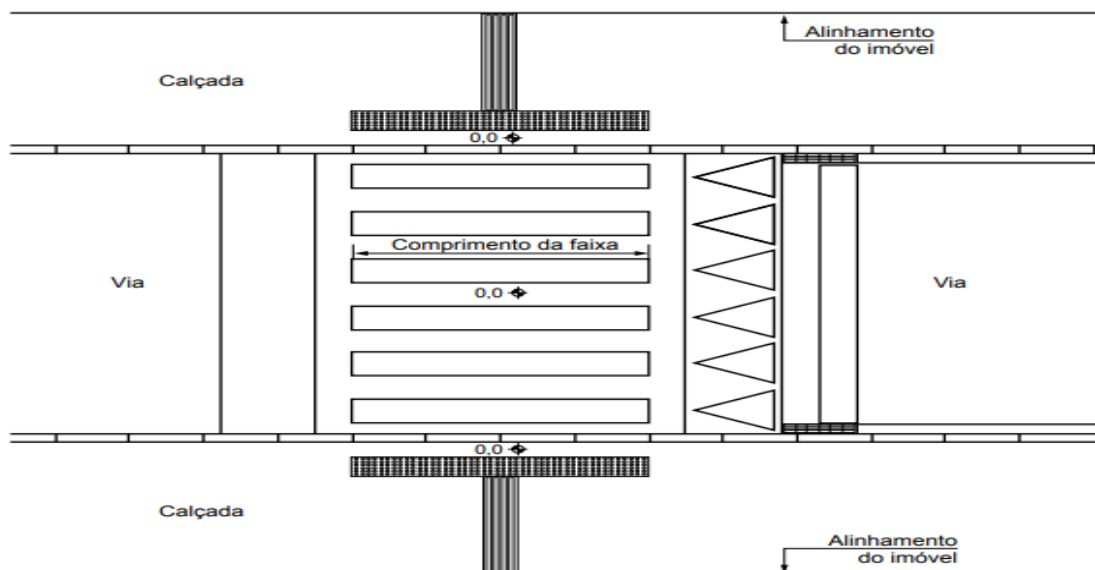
Vista superior de faixa elevada para travessia de pedestres.
